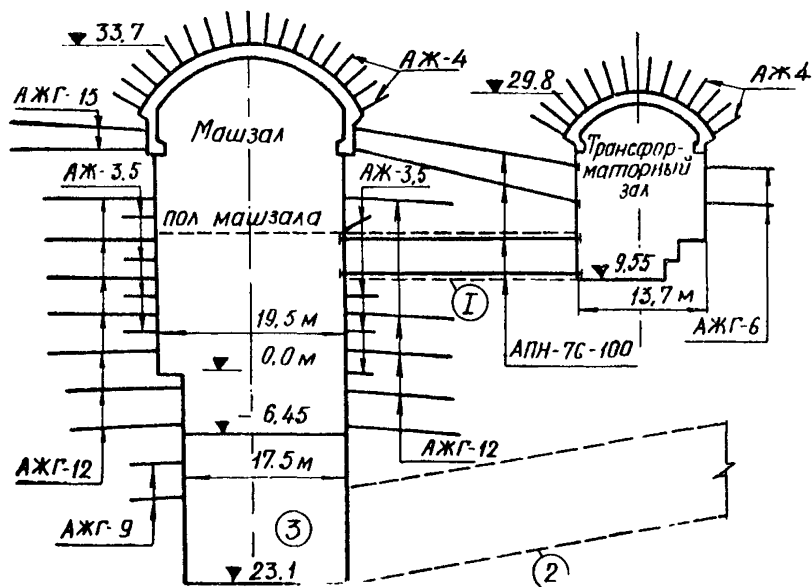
Схема анкерного крепления выработок здания станции ГЭС Хоабинь (СРВ):
